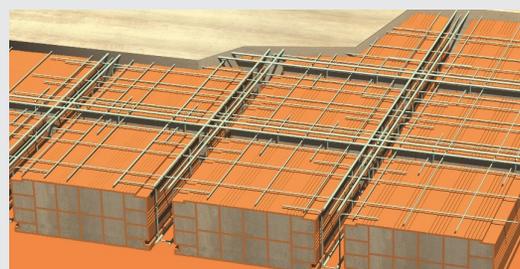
Forjado reticular con nervios hormigonados "in situ"
